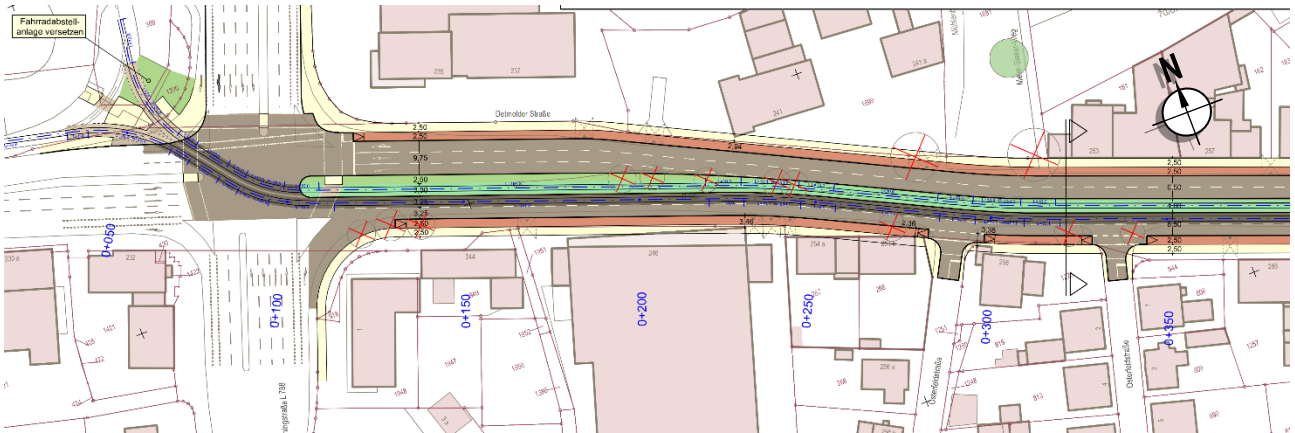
Trassenvariante 1 - Detmolder Straße Abschnitt Sieker bis Flensburger Straße
